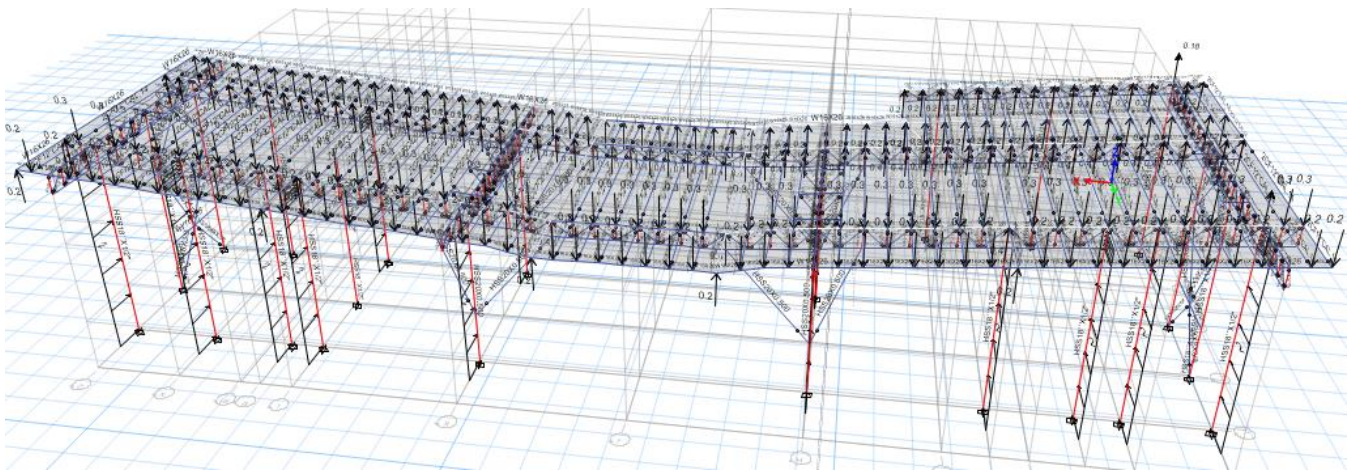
Aplicación de cargas por viento en dirección Y (Estructura armaduras).
